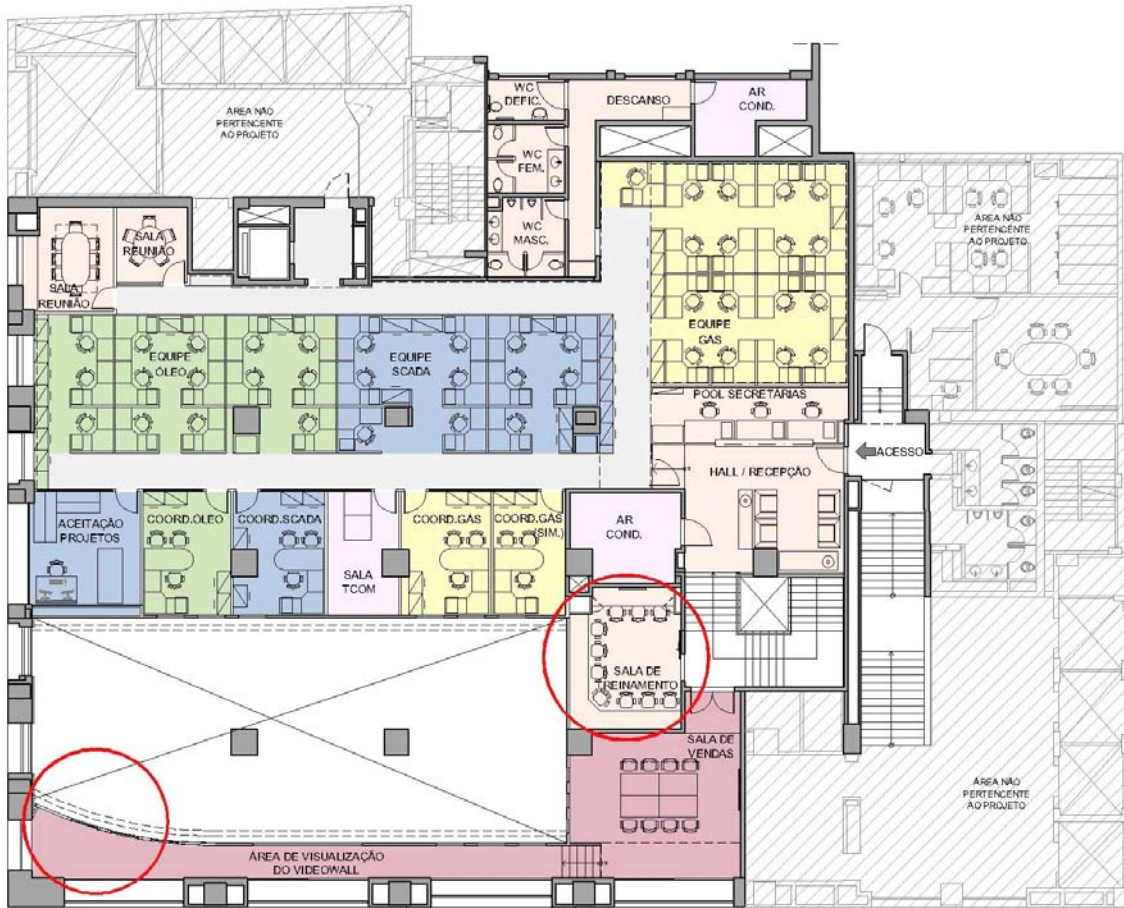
Planta baixa mezanino: layout apresentado na entrega do *milestone 5
